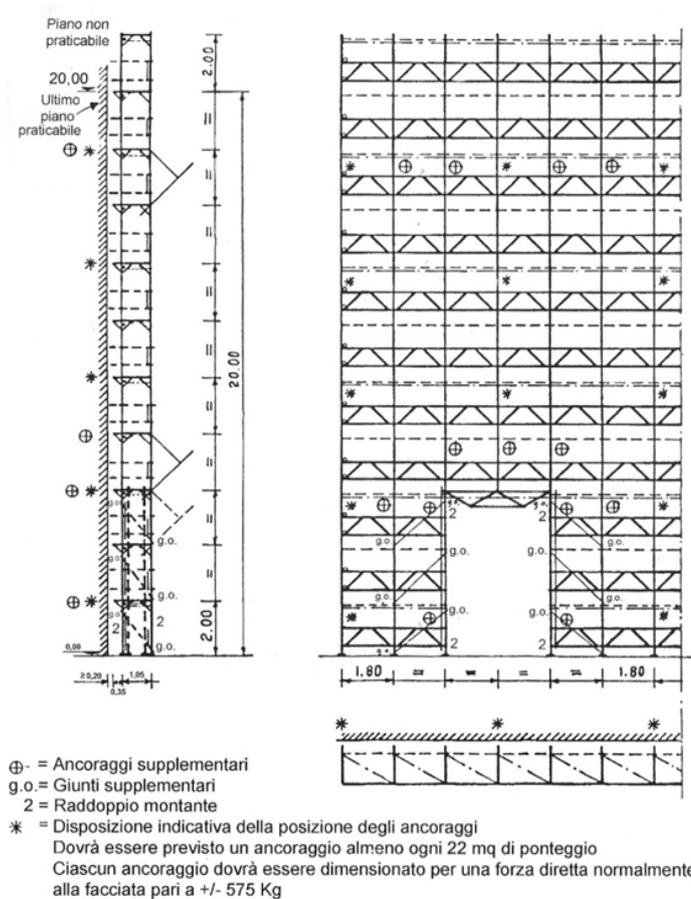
Schema tipo ponteggio a telai prefabbricati, tratto da una autorizzazione ministeriale
